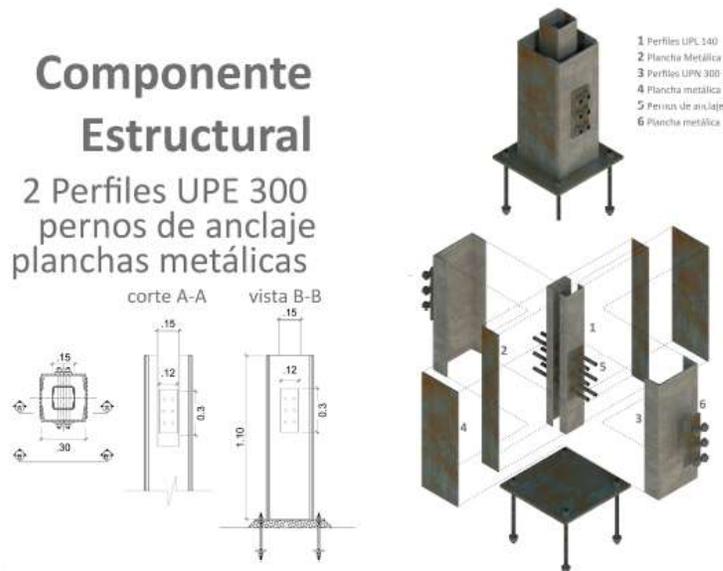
Componente Estructural. Fuente: Elaboración Propia
